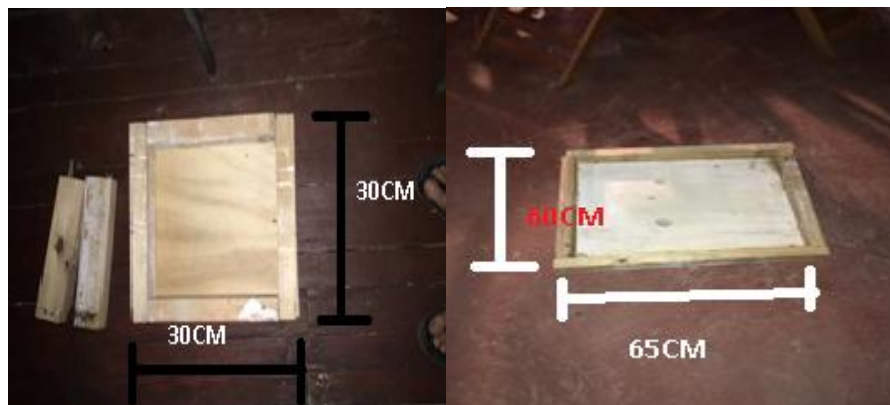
Moldes de 30*30 y molde de 60*65cm.
